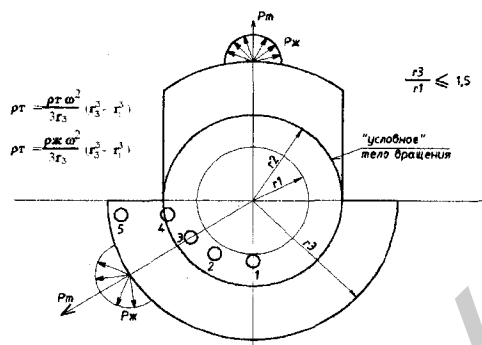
Схема действия жидкой и твердой фаз бетонной смеси на стенки формы ригеля таврового сечения
